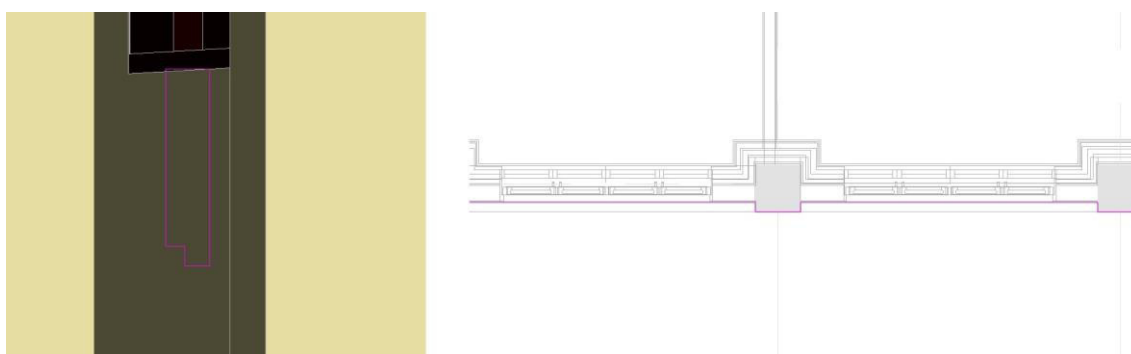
Perfil de barrido de saliente de fachada (izquierda) y ruta de barrido (derecha)
